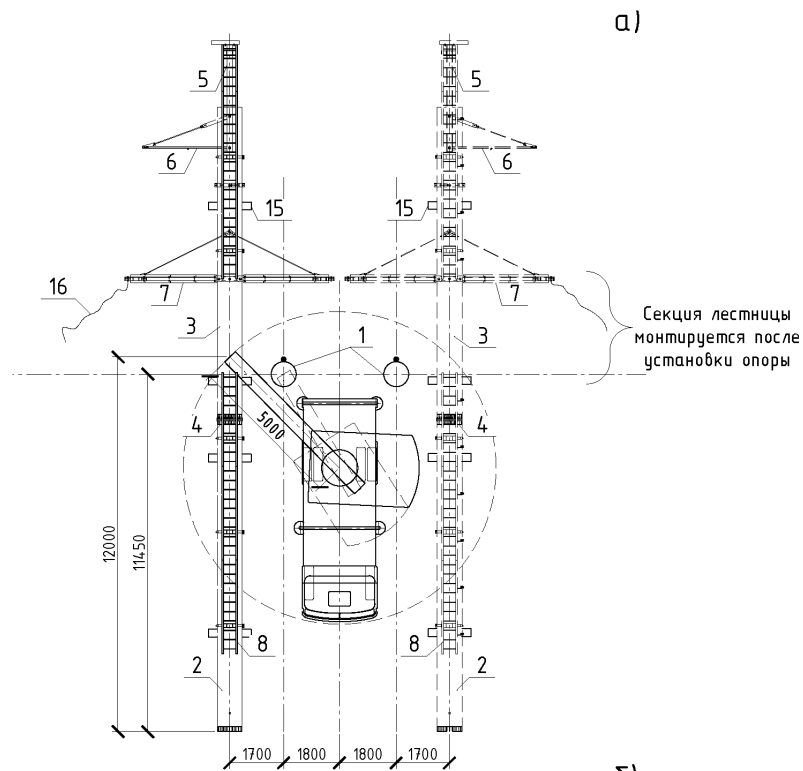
Схема сборки и монтажа опор 2СУБ110-5Ф
